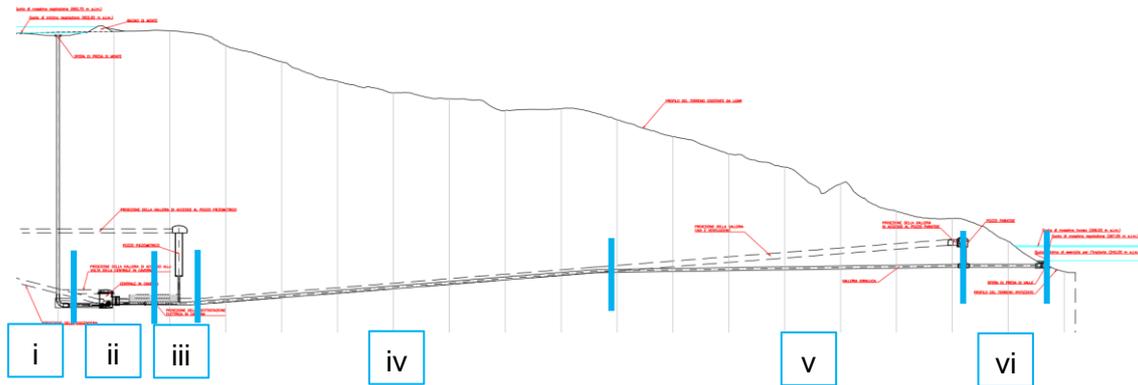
Sezione longitudinale con individuazione delle sei tratti sopra descritte
